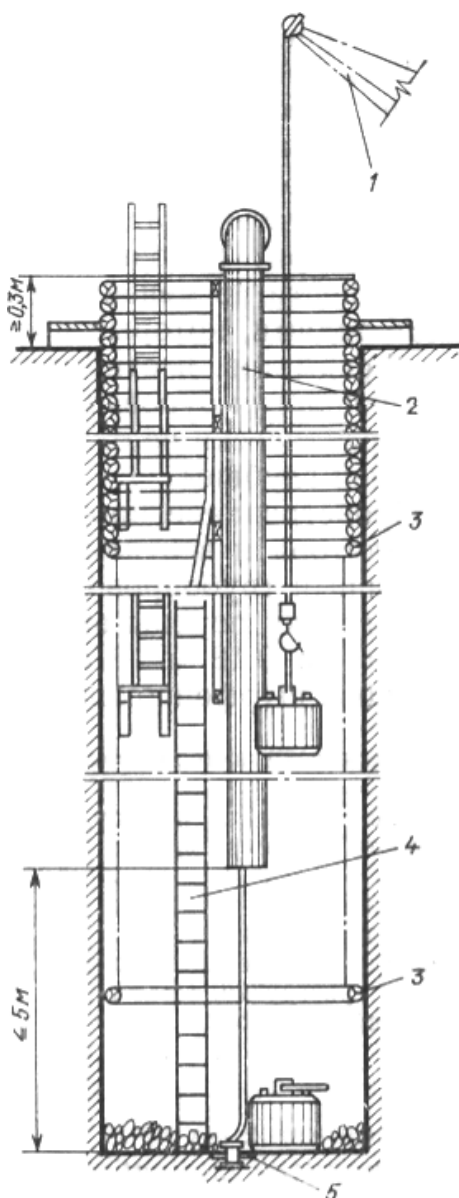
Схема проходки глубоких шурфов буровзрывным способом: 1 – шурфопроходческий подъемник; 2 – вентиляционный трубопровод; 3 – венцы; 4 – подвесная лестница; 5 – погружной забойный насос
